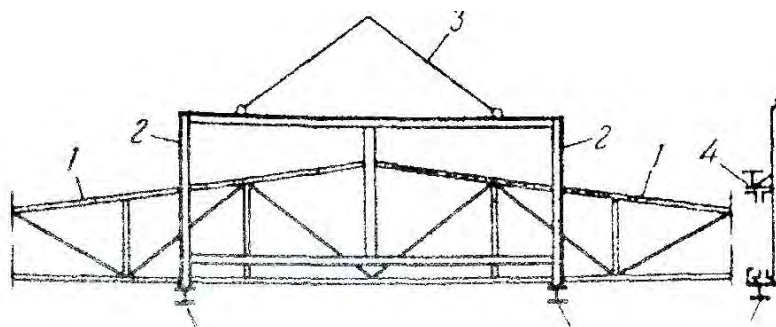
Траверса для монтажа ферм: 1 - ферма; 2 — траверса; 3 -стропы; 4- фиксаторы нижнего и верхнего поясов фермы; 5 — домкраты
